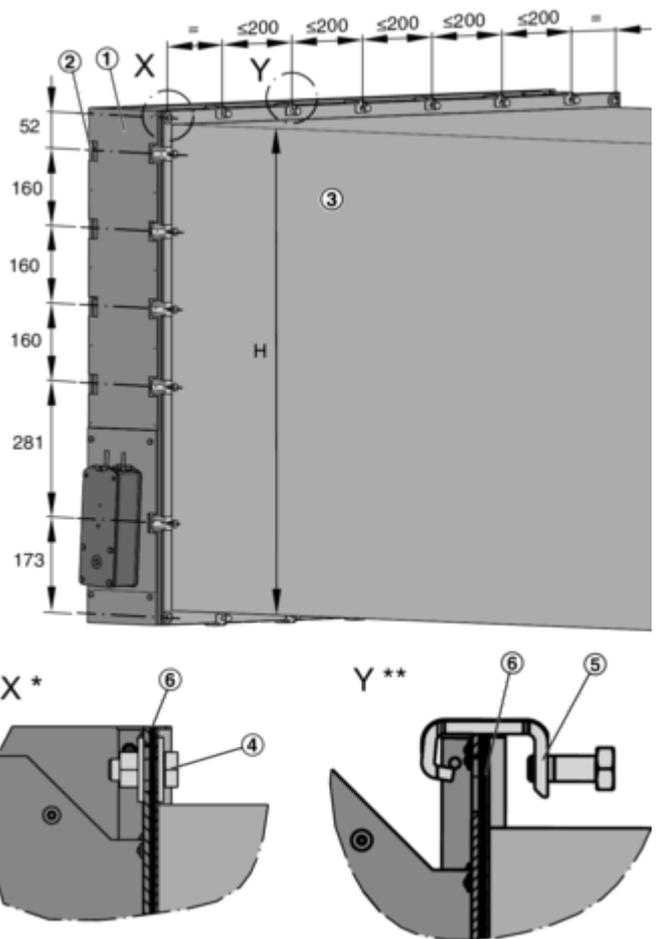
EK-JS Anschluss Luftleitung mit Kanalklammern
